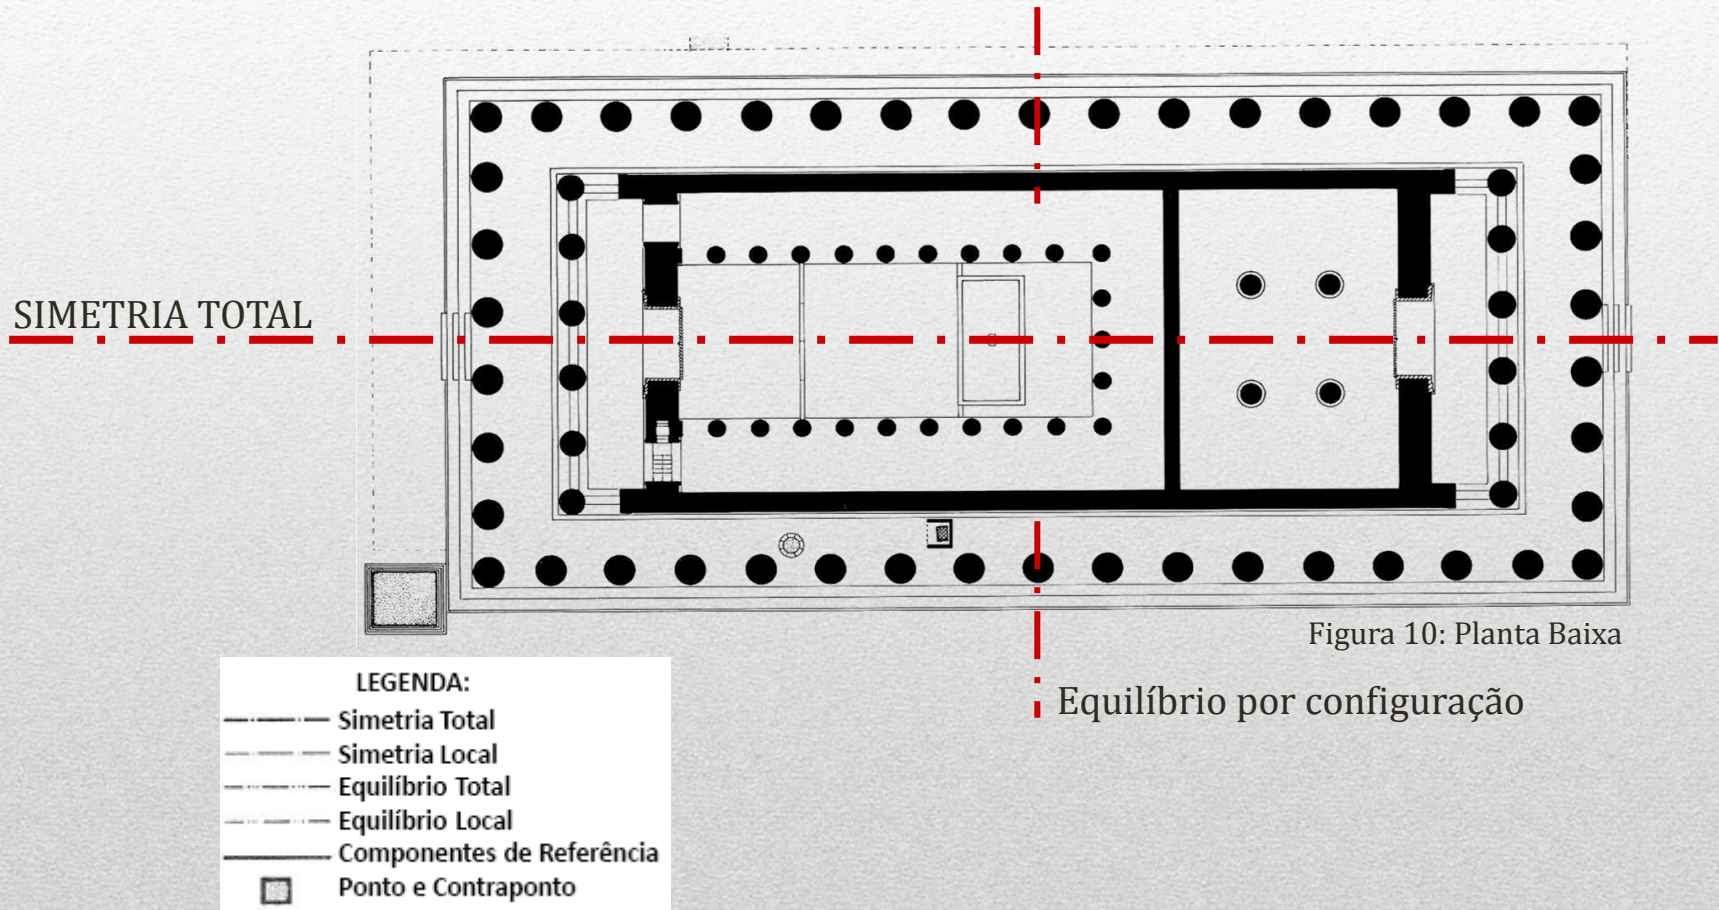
Planta Baixa SINGULAR DEFINIDO PELO REPETITIVO
